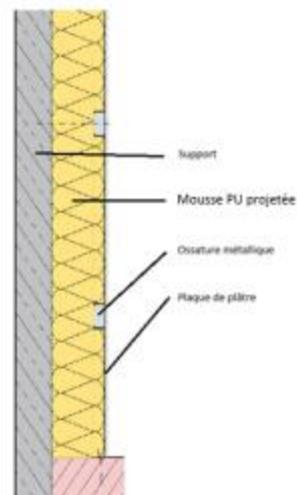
Projection au niveau des rails sans lame d'air (ERP)
